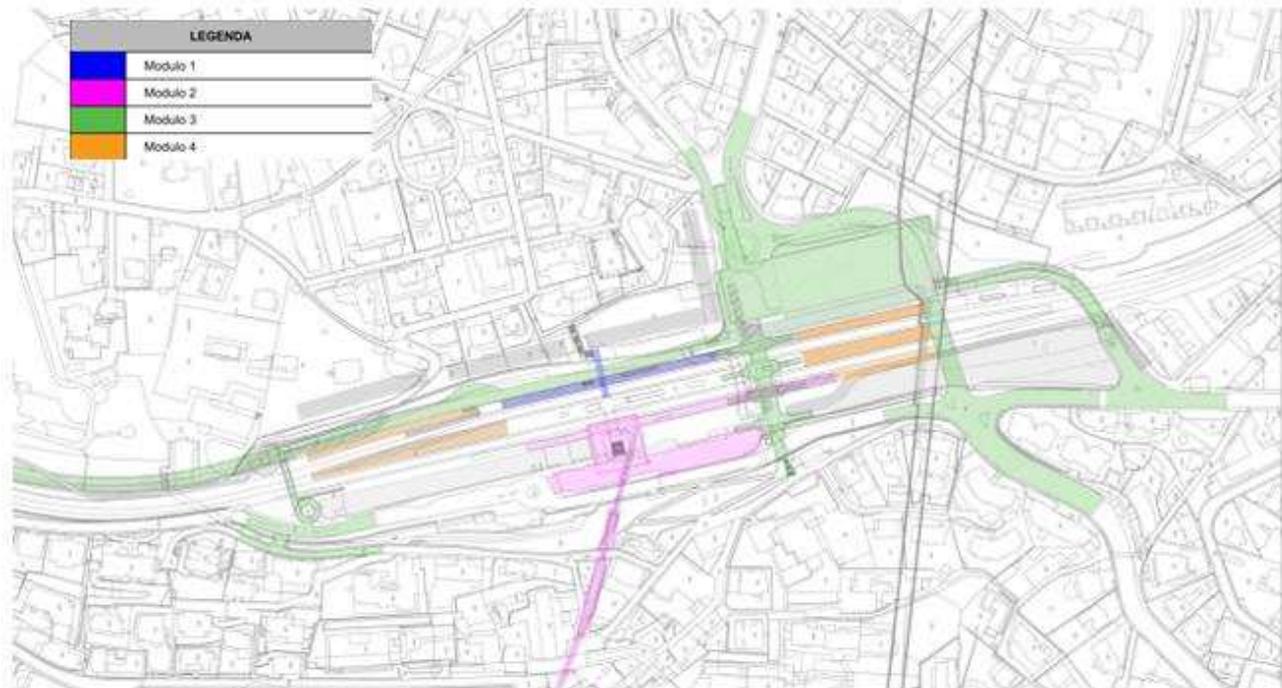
Planimetria generale degli interventi nell'area della stazione.
